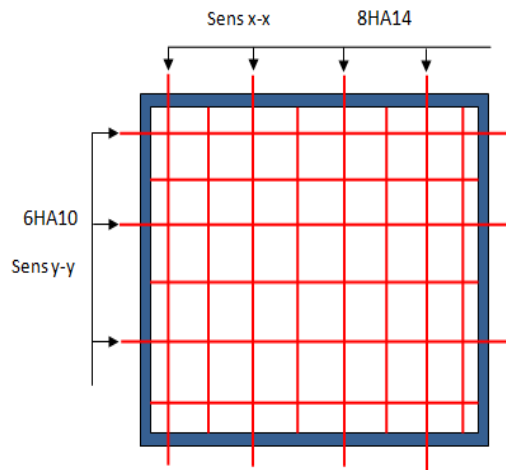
Vue sur plan de Ferrailage transversal de la semelle.
